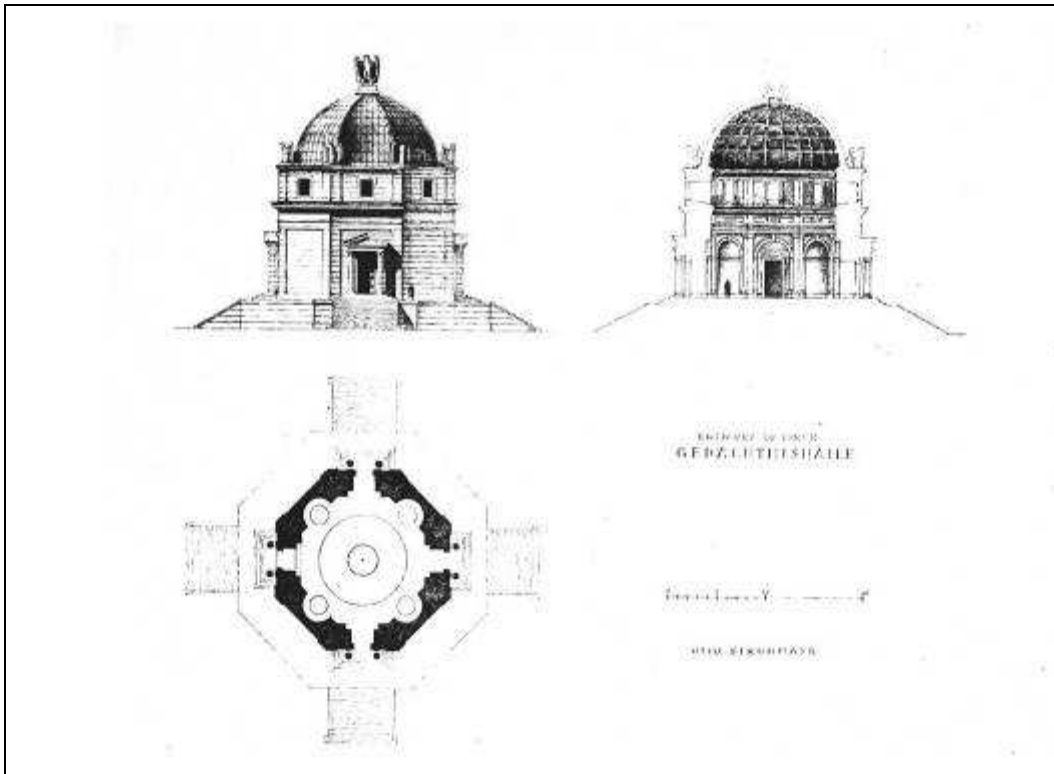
Otto Strohmayer, *Entwurf zu einer Gedächtnishalle*, Salzburg , undatiert (Sammlung Fais-Månsson).
